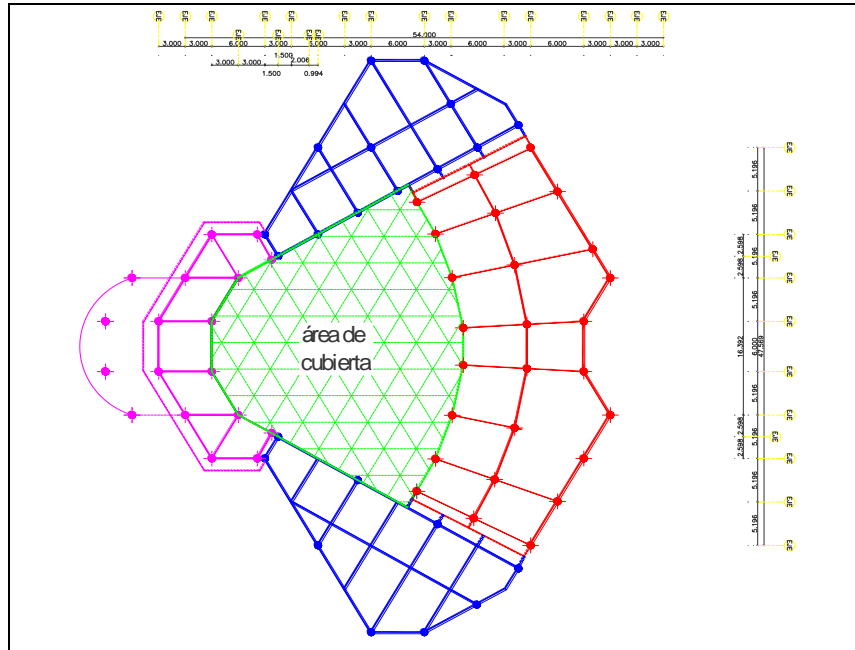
Planta Alternativa estructura Auditorio ESPE
